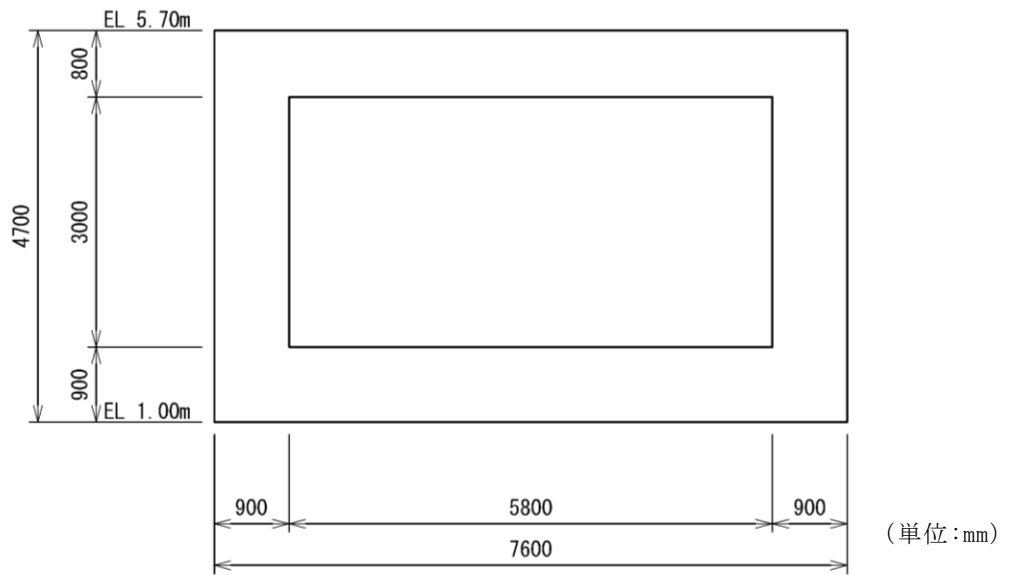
屋外配管ダクト (タービン建物～放水槽) 断面図 (C-C 断面)
